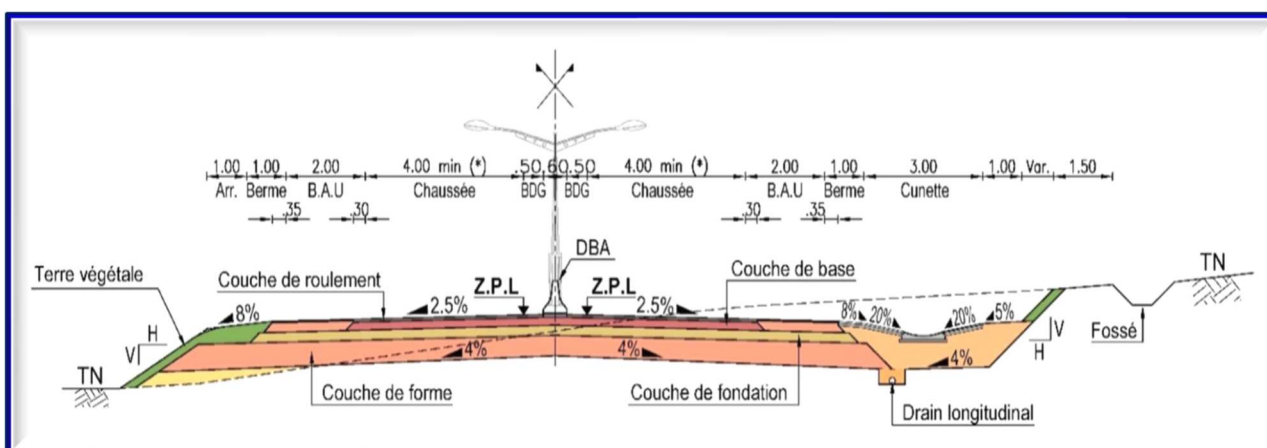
Profil en travers type des bretelles et branches bidirectionnelles
